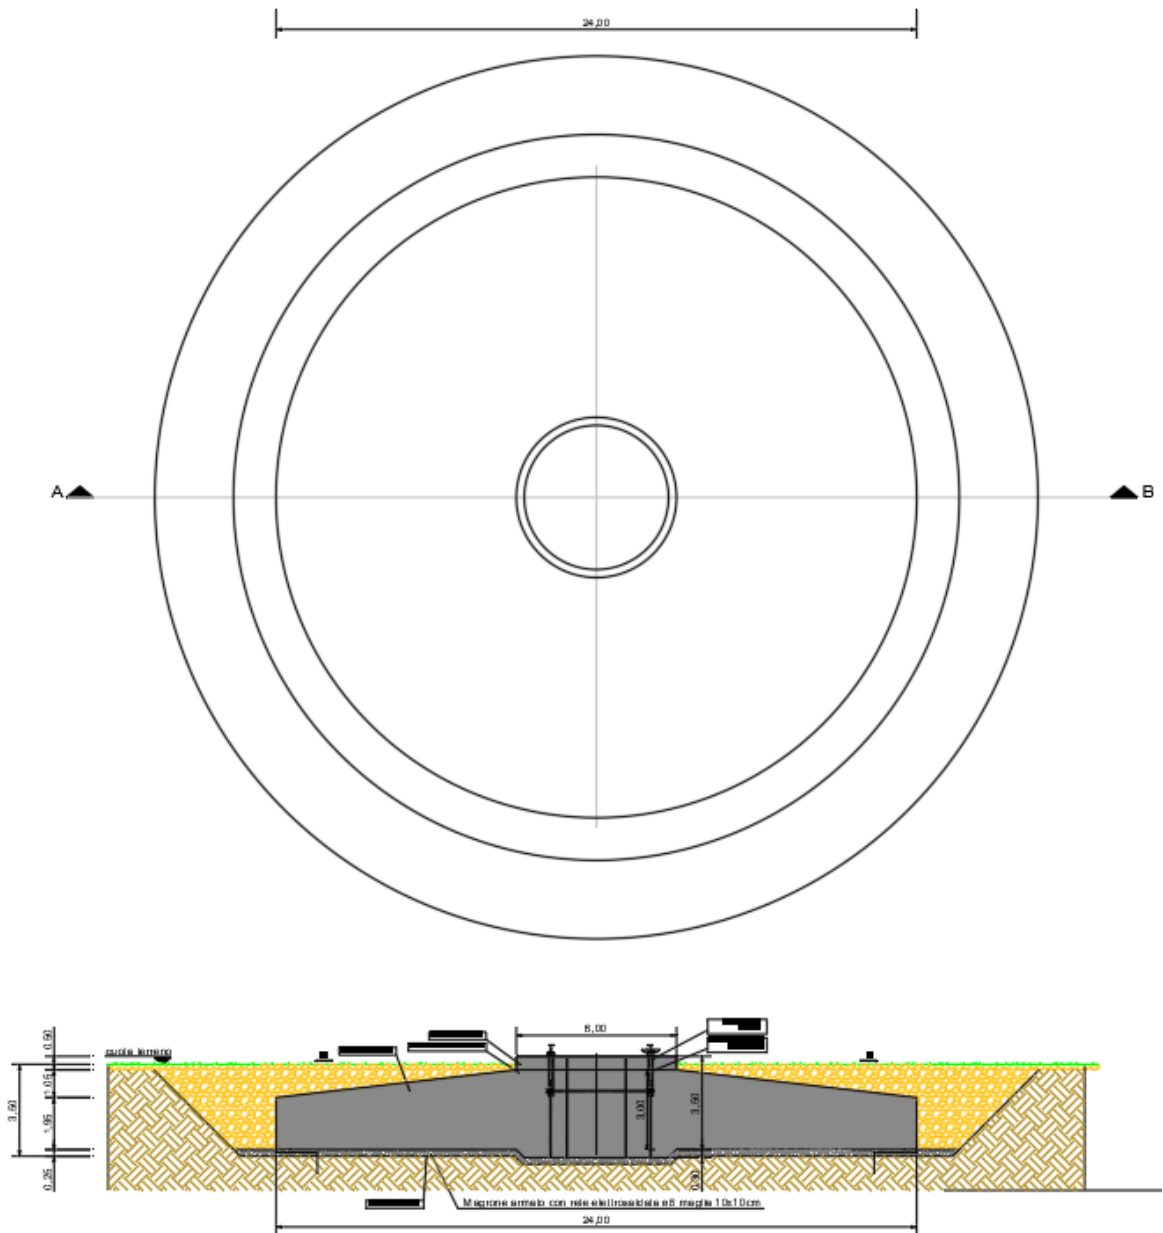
FONDAZIONE DIRETTA – PLATEA IN SEZIONE E CARPENTERIA
